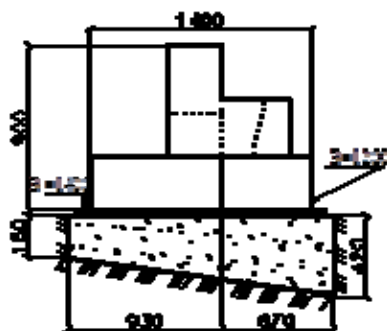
Блочный ступенчатый фундамент с бетонной подготовкой
